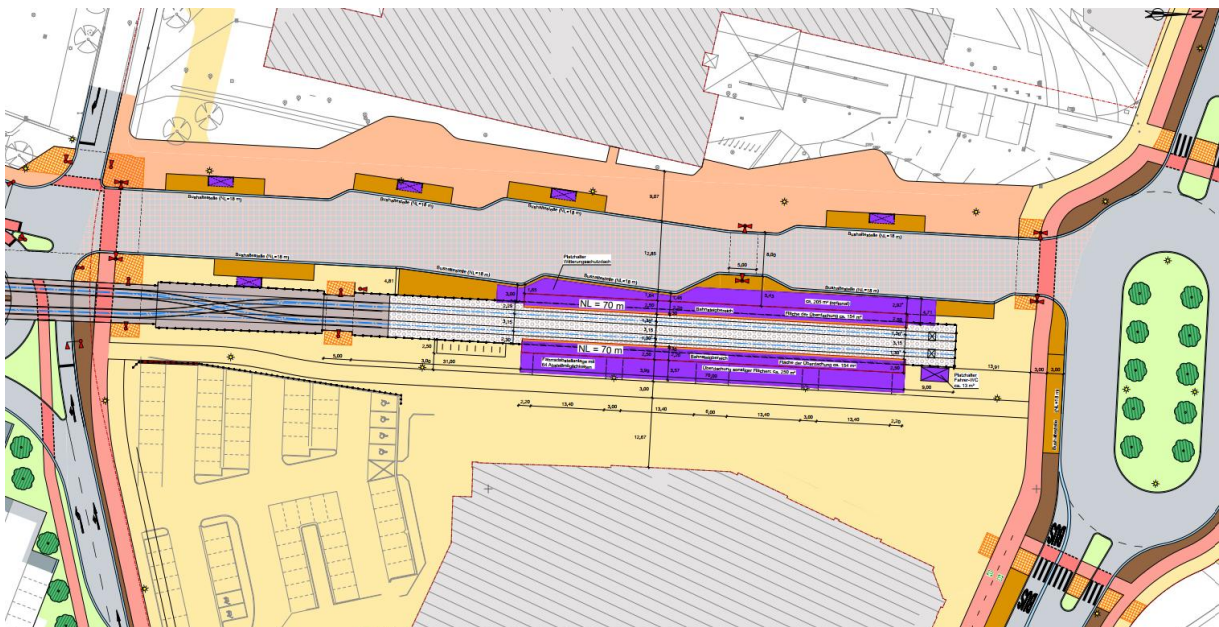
Lageplan Endhaltestelle – Darstellung der Mindestflächen, die zu überdachen sind (lila)
